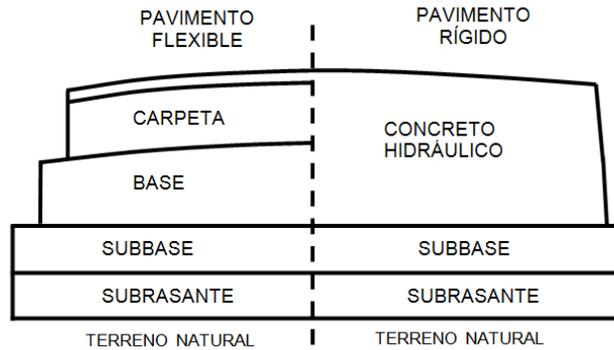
Estructuración típica de pavimentos flexibles y rígidos
